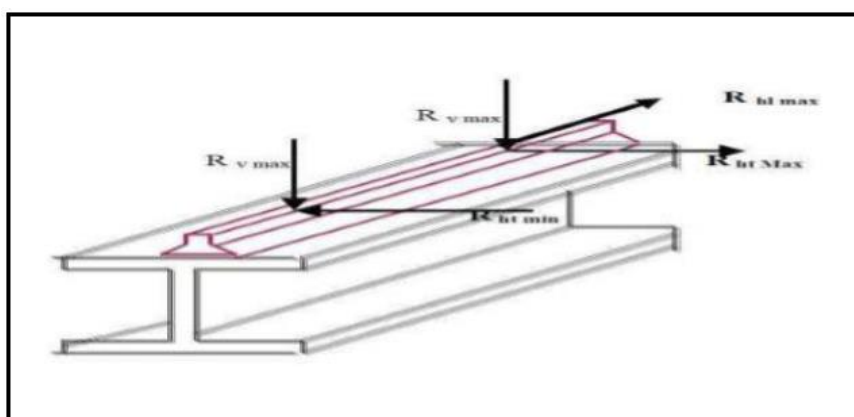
Schéma de la poutre de roulement avec le rail.
